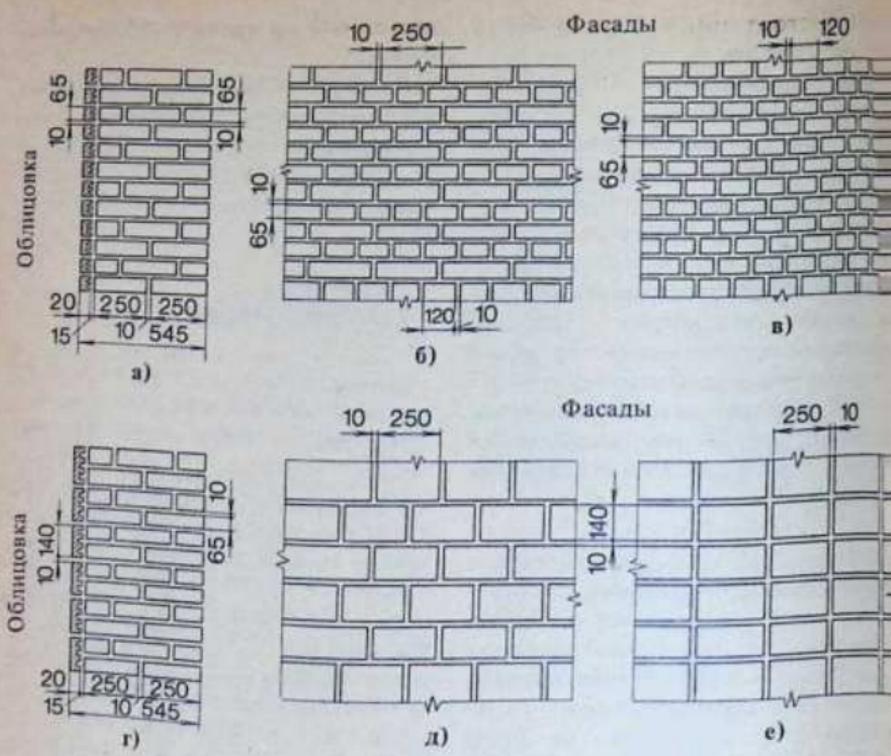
Облицовка кладки из кирпича прислонными керамическими плитками:
